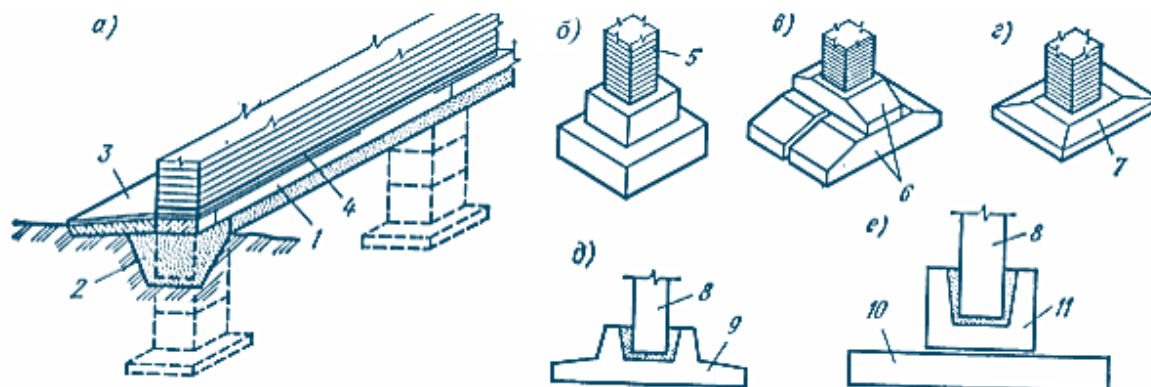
Стовпчасті фундаменти: 1 – залізобетонна фундаментна балка; 2 – підсилення; 3 – вимощення; 4 – гідроізоляція; 5 – цегельний стовп; 6 – блок-подошукки; 7 – залізобетонна плита; 8 – залізобетонна колона; 9 – башмак склянкового типу; 10 – плита; 11 – блок-склянка
